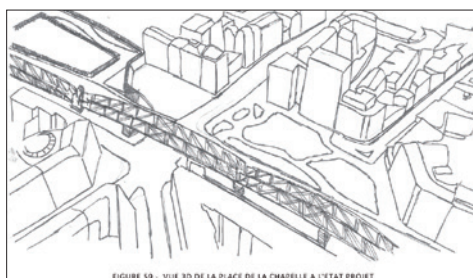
VUE 3D DE LA PLACE DE LA CHAPELLE A L'ETAT PROJET
